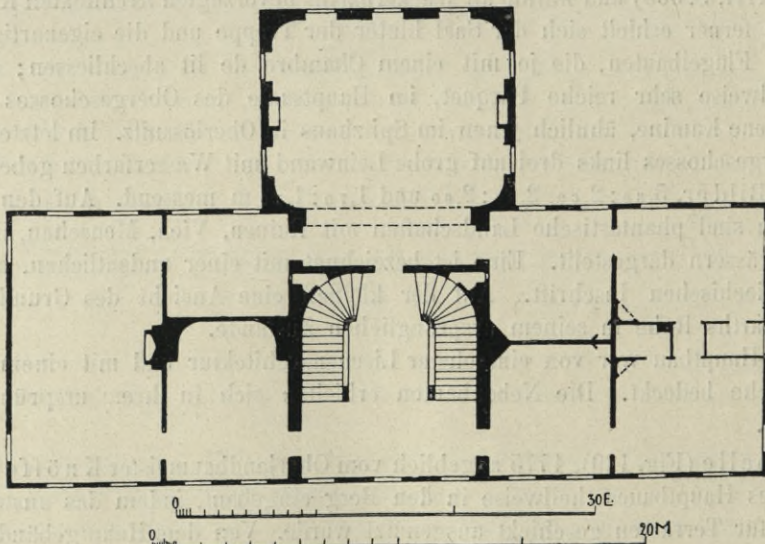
Niederlössnitz, Wackerbarths Ruhe, Grundriss des Obergeschosses.
